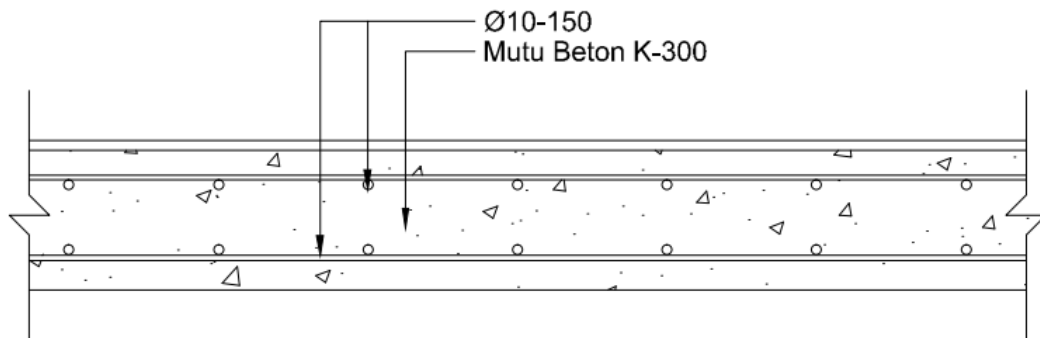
Denah Rencana Plat Lantai Elv. + 14.04
